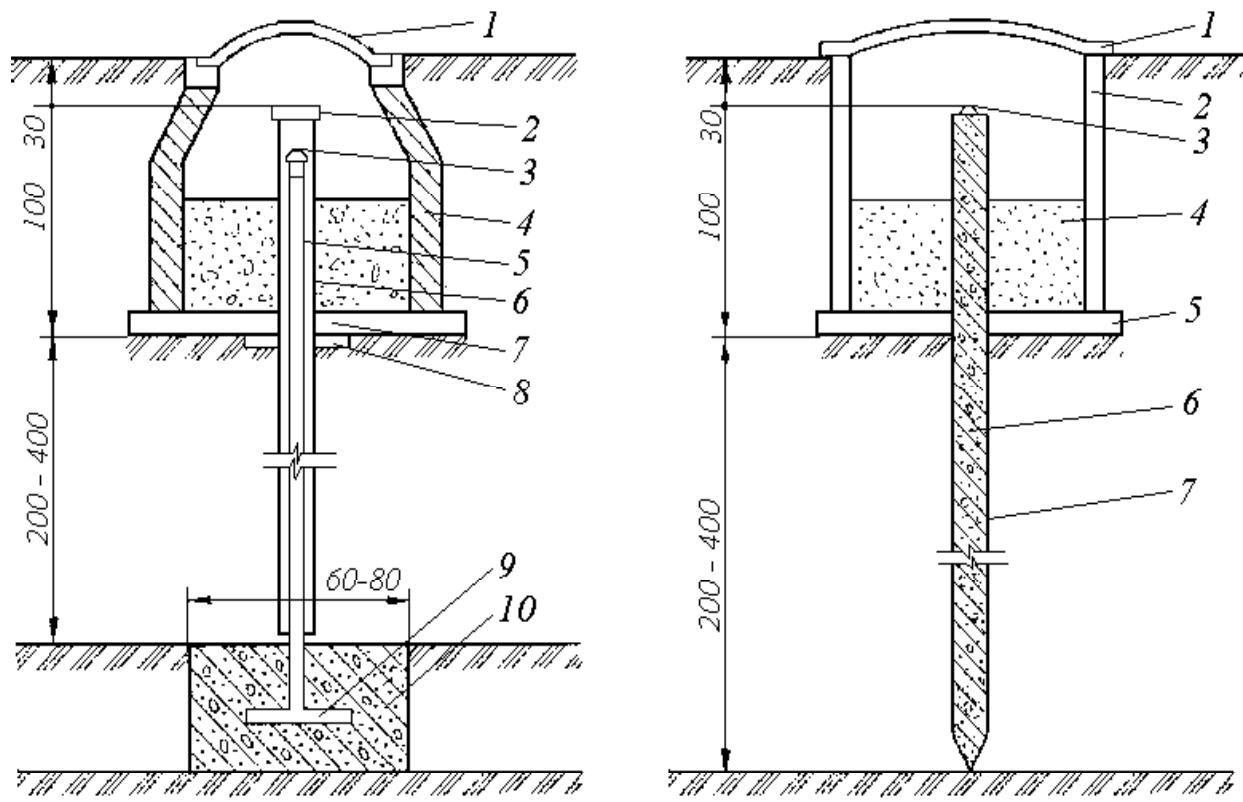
Грунтовий репер: а) трубчастий на бетонному фундаменті: 1 – люк; 2 – кришка; 3 – реперна головка ( $\varnothing$  2–4 см); 4 – цегляний або бетонний збірний колодязь; 5 – реперна труба ( $\varnothing$  7–8 см); 6 – захисна труба ( $\varnothing$  12–15 см); 7 – бетонна підготовка; 8 – хомут для утримання захисної трубы; 9 – анкерний лист; 10 – бетонна подушка; 11 – шлак; б) пальовий: 1 – люк; 2 – цегляний або бетонний збірний колодязь; 3 – реперна головка ( $\varnothing$  2–4 см); 4 – шлак; 5 – бетонна підготовка при встановленні в котлован; 6 – паля; 7 – бітум
